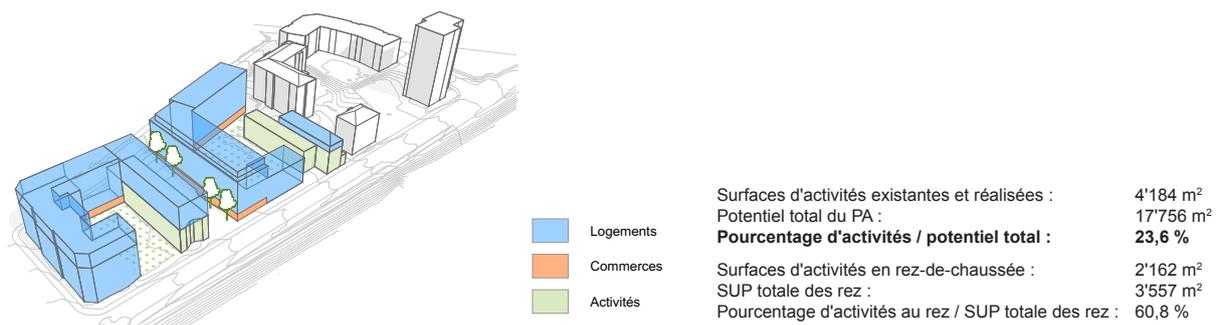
Étape n°3 avec la démolition et reconstruction du bâtiment «Moulins 46-48»
